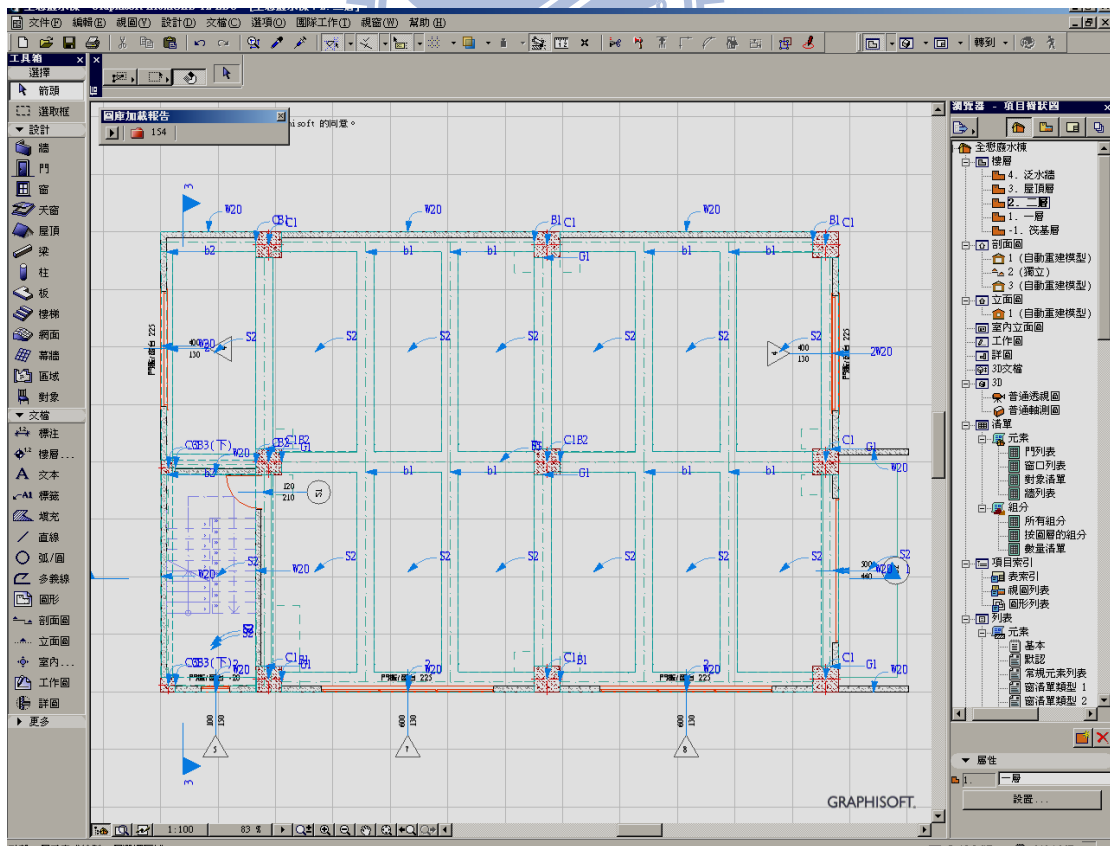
ArchiCAD 實例 2D 平面圖
